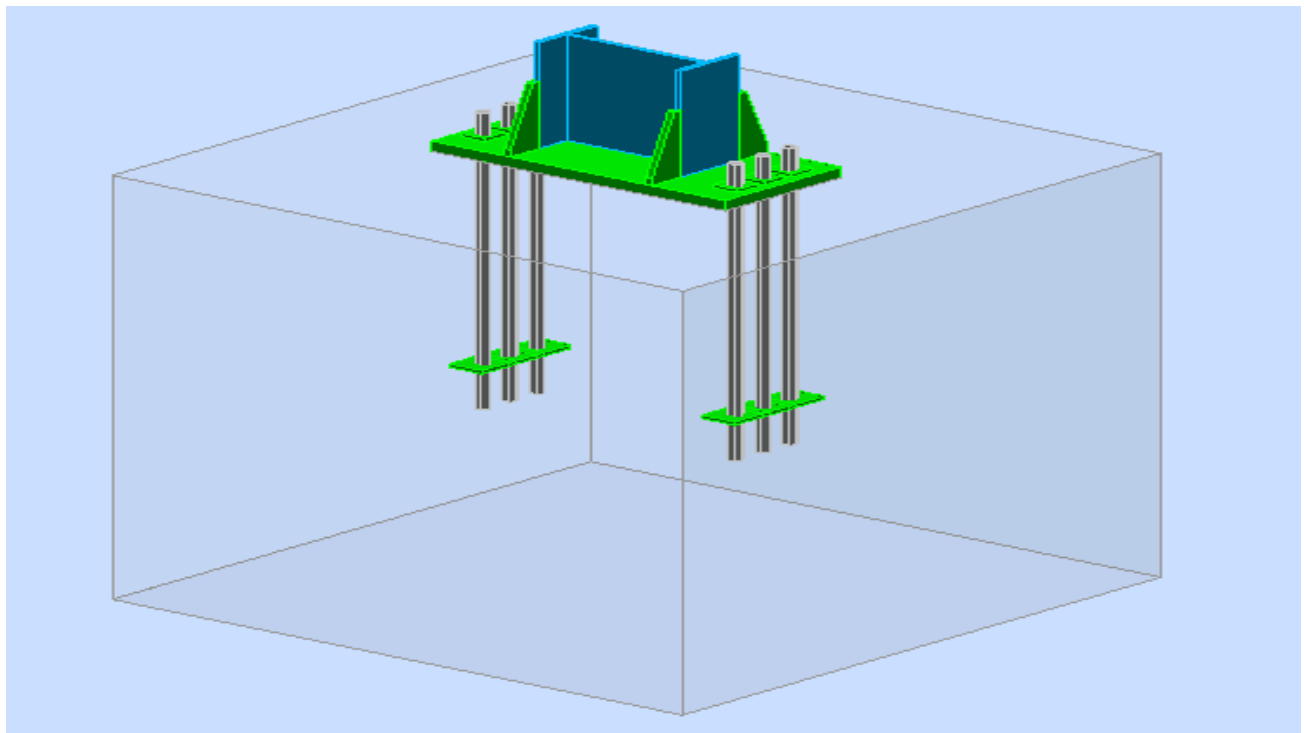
Vue 3D de la jonction poteau-fondation.
